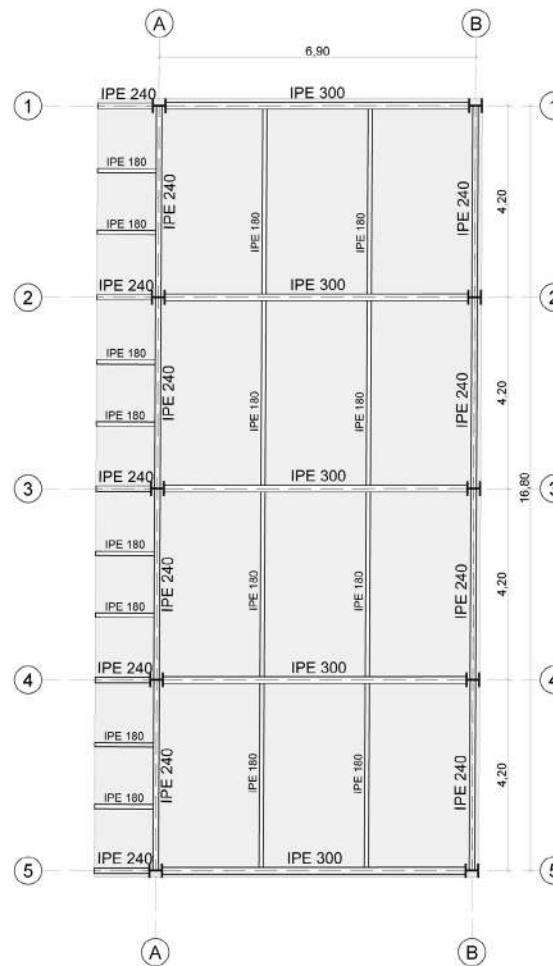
Planta estructural completa Fuente: Elaboración Propia
